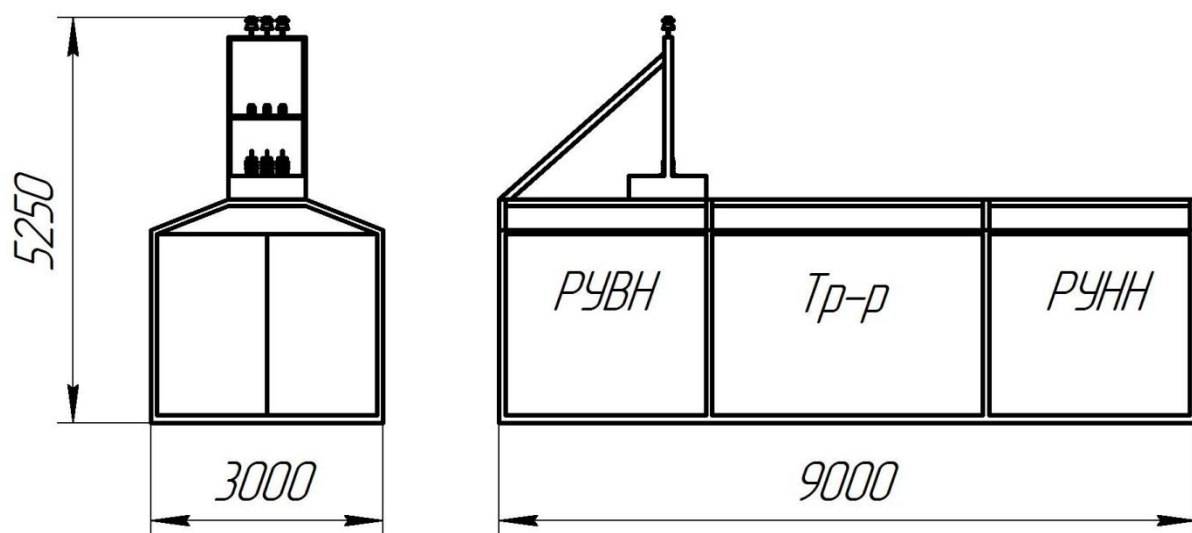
Схематичный общий вид КТПН-БТВК-630...2500-10(6)/0,4-УХЛ1
